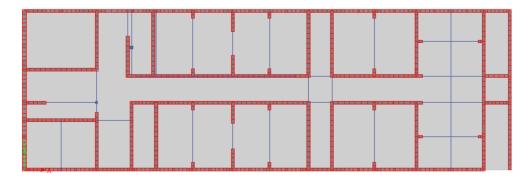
Planta primer piso, Colegio Madres Domínicas Edificio 1.
